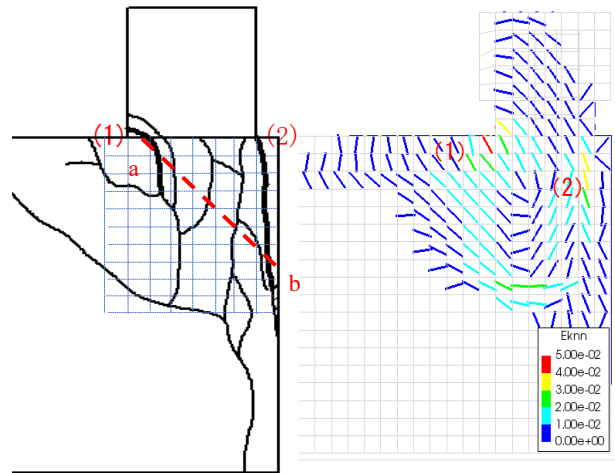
切断面のひび割れ状況(左:実験, 右:解析)
